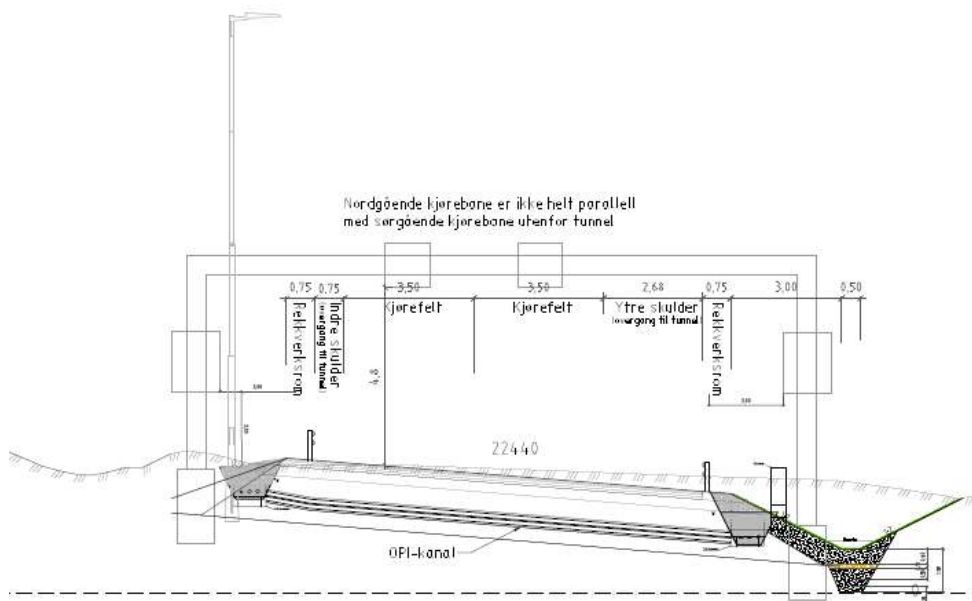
Illustrasjon av planforslaget (Illustrasjon av Rambøll).
